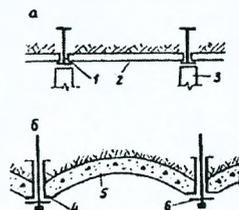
Ограждение откоса котлована свободно стоящим закладным креплением
